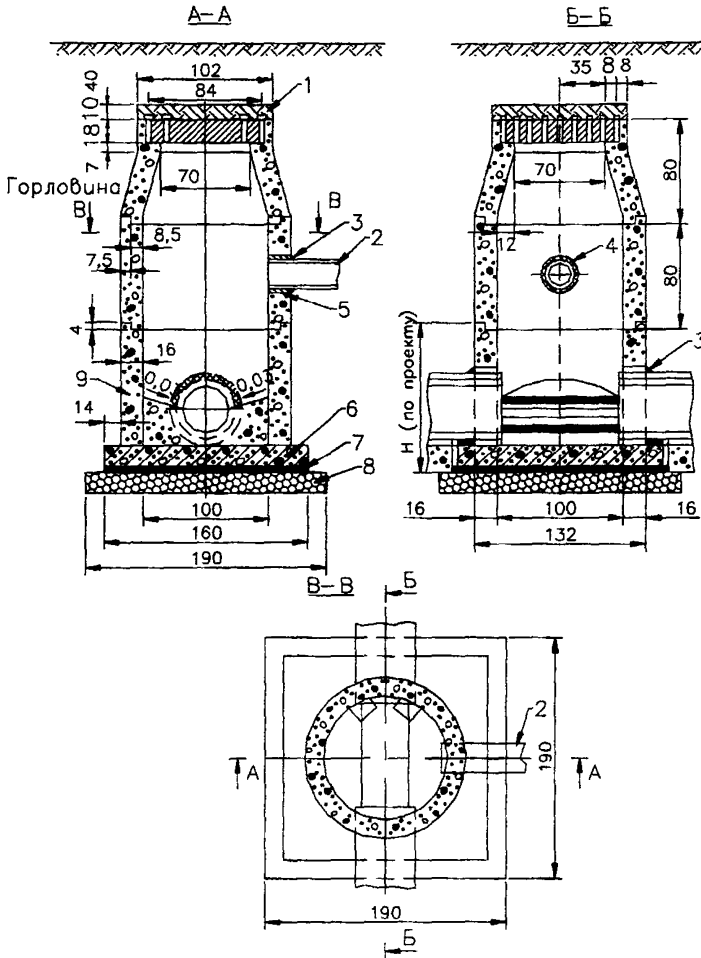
Круглый смотровой колодец (сборный из железобетонных звеньев):
